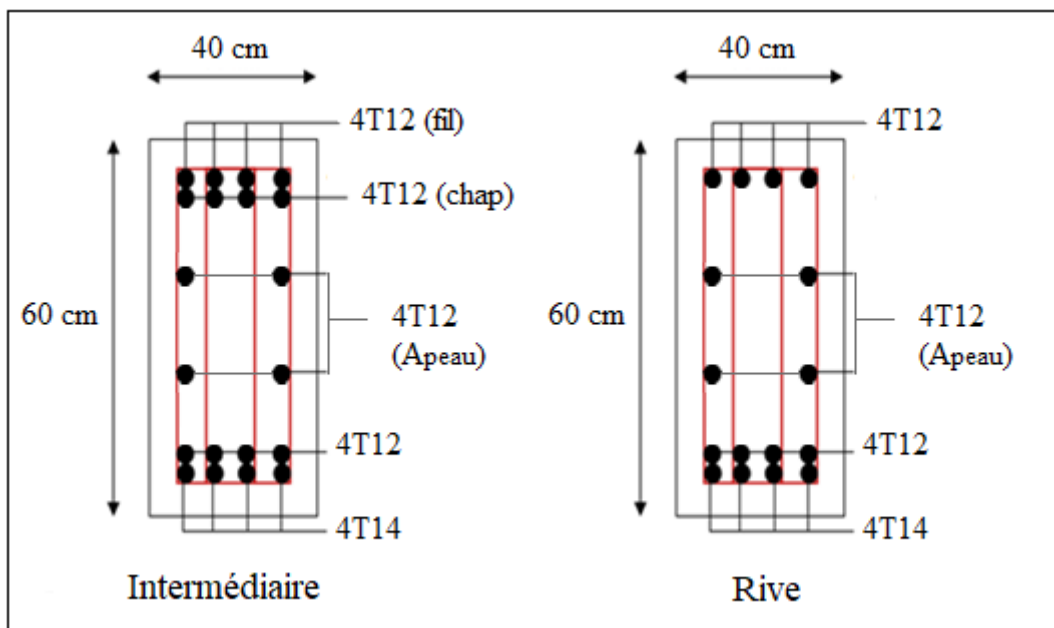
Ferrailage de la poutre de libage suivant le sens longitudinale.
